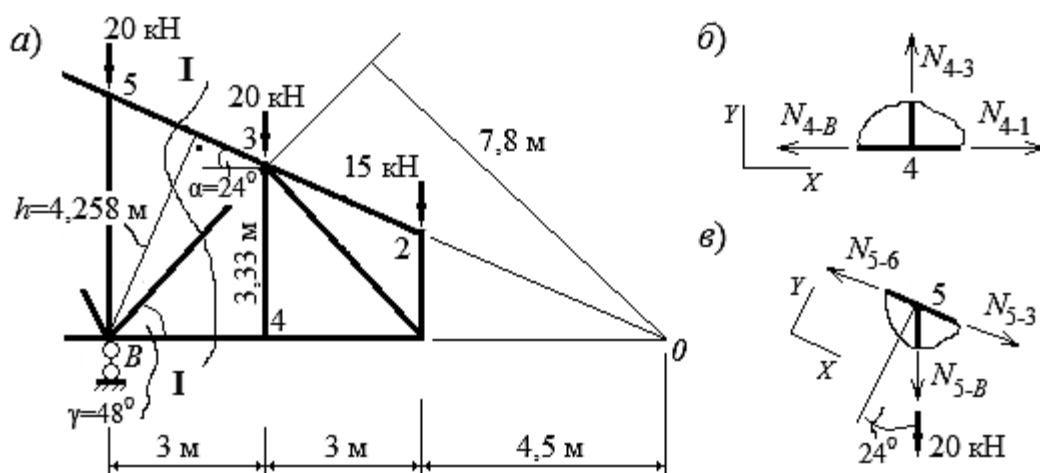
К определению усилий в стержнях плоской фермы от действия заданной нагрузки
